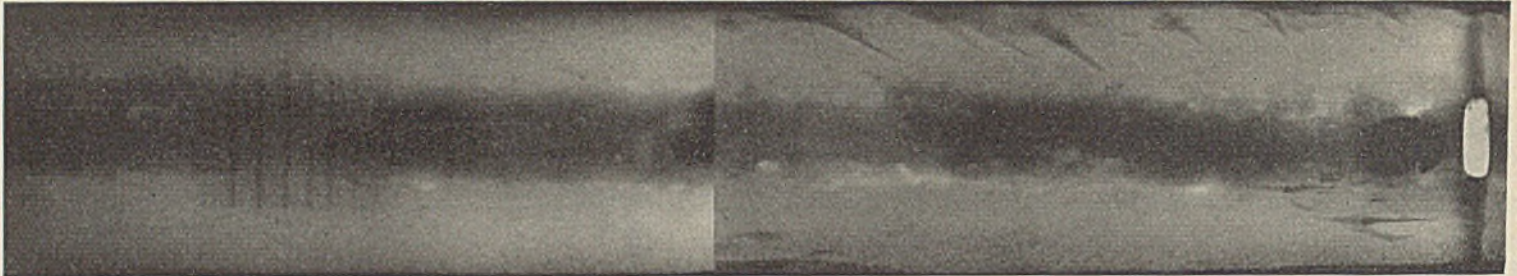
Baustellen-Röntgenaufnahme des Stehblechstoßes (13—14 des Hauptträgers I).
